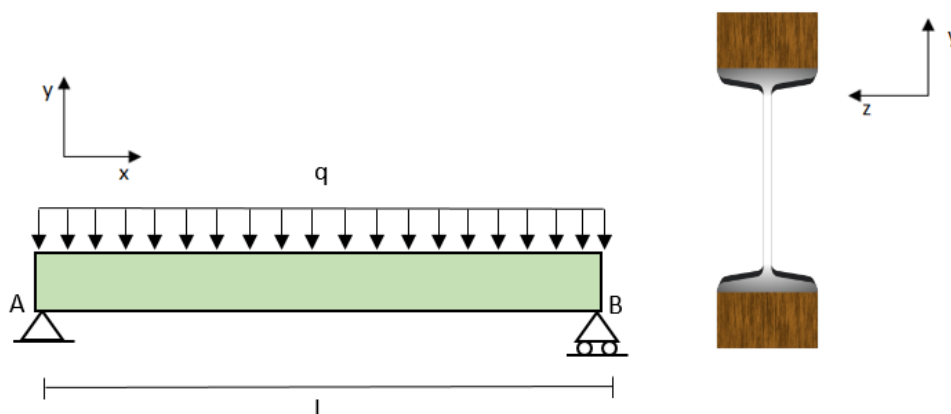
Viga de acero IPN200 con dos refuerzos de madera sometida a flexión simple, sección transversal y condiciones de contorno.
